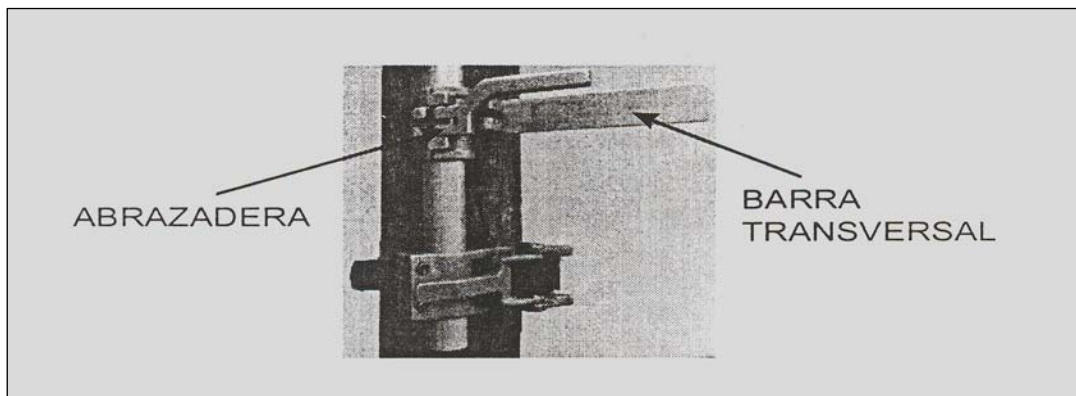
Sujeción de la Abrazadera Para Empalme en Poste.
